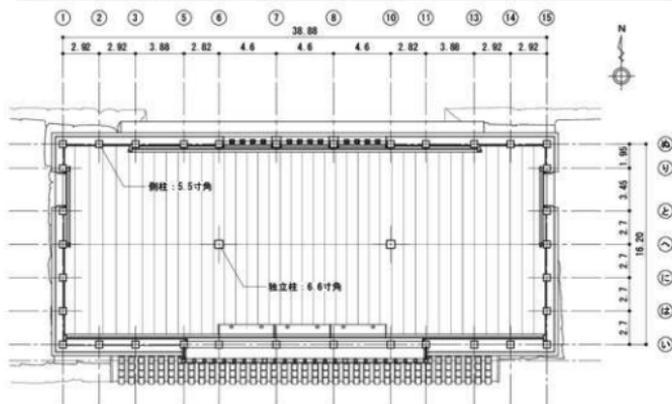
櫓 (2階) 平面図 (単位: 尺)
